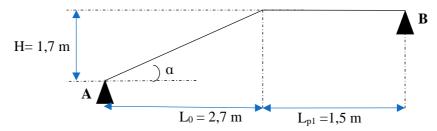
Coupe en élévation de l'escalier (type 1).
